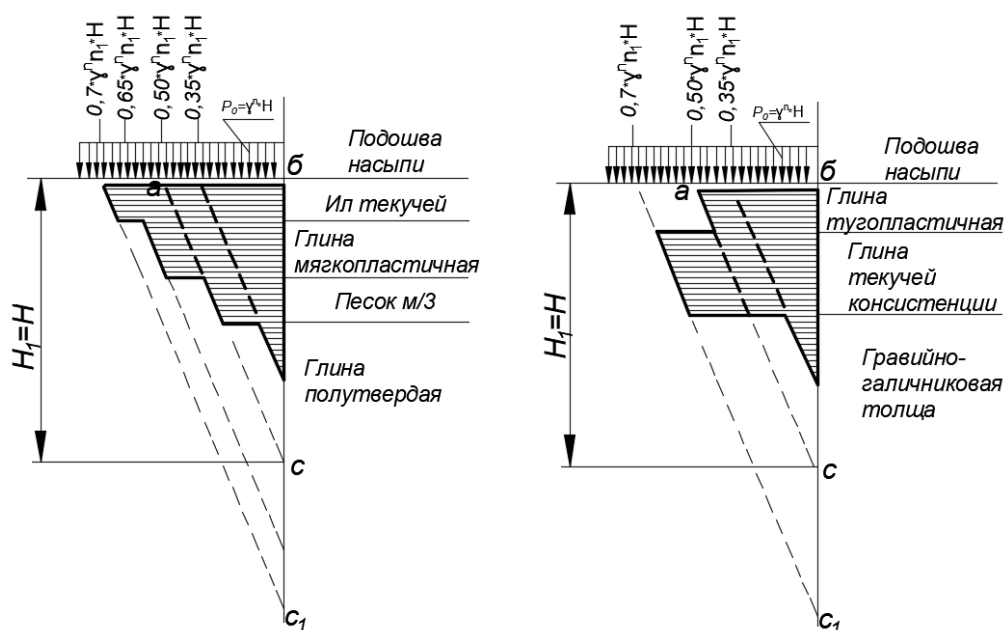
Схема к расчету избыточного горизонтального давления грунта ниже естественной поверхности от веса подходной насыпи
